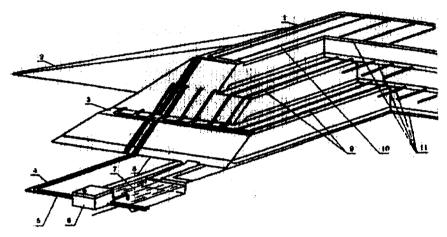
Схема кучного выщелачивания на месторождении Маныбай: 1 — штабель КВ; 2 — заезд на штабель; 3 — уступ штабеля; 4 — трубопровод рабочих растворов; 5 — трубопровод сжатого воздуха; 6 — насосная станция; 7 — зумпф продуваемых растворов; 8 — гидронепроницаемое основание; 9 — аэрационная система; 10 — оросительная система; 11 — слои из мелкозернистого материала
